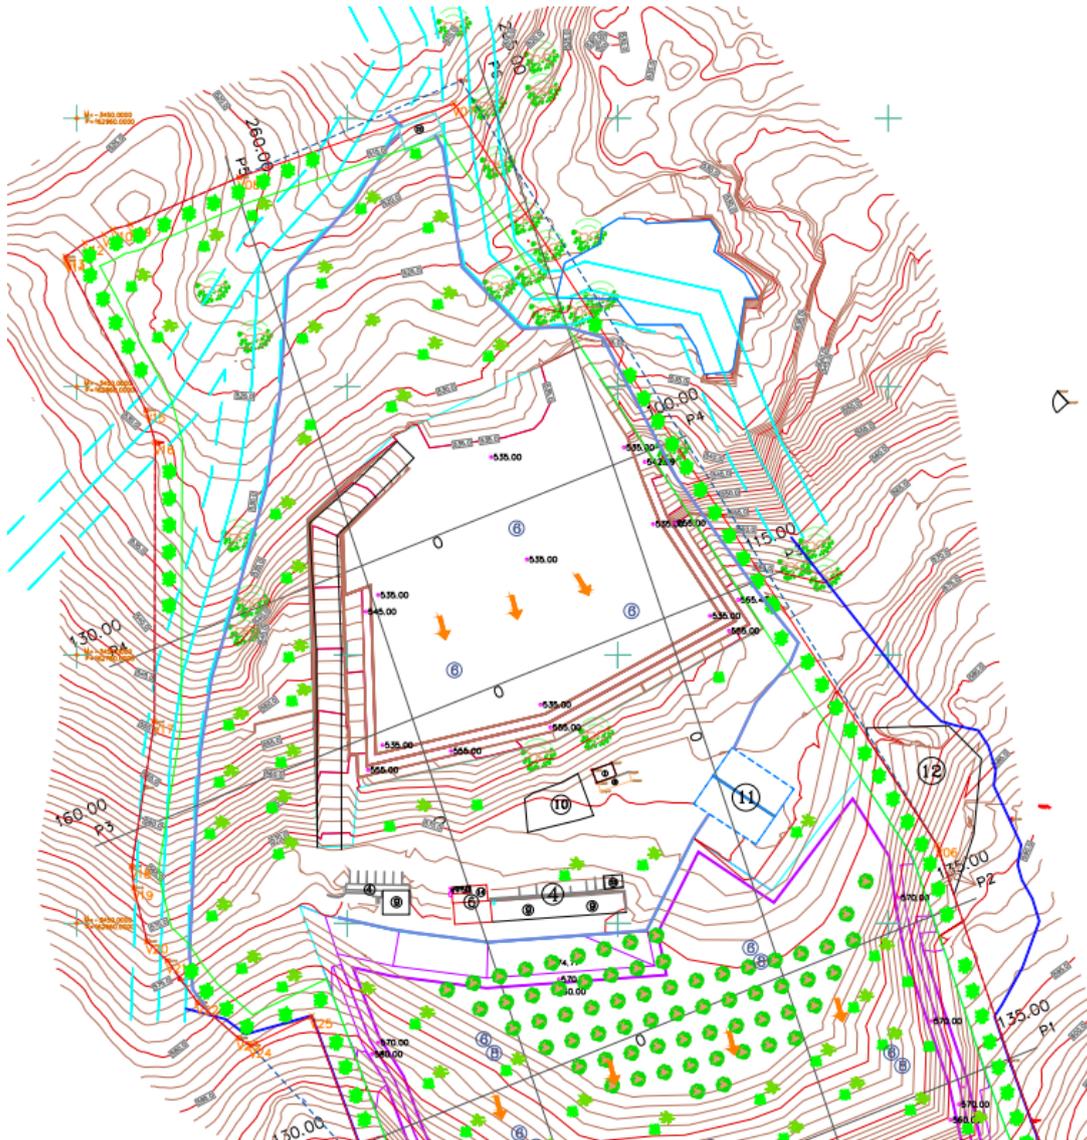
Excerto do traçado da rede de drenagem (D09_Planta de Escavação Final).
